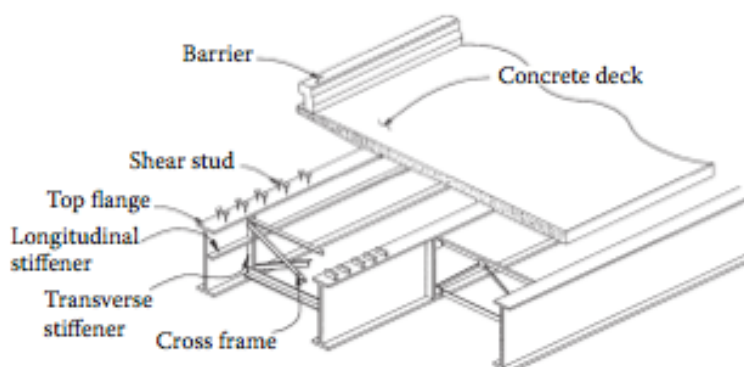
Componentes Típicos de Viga con Perfil Tipo "I" (Chen & Duan, 2014).
